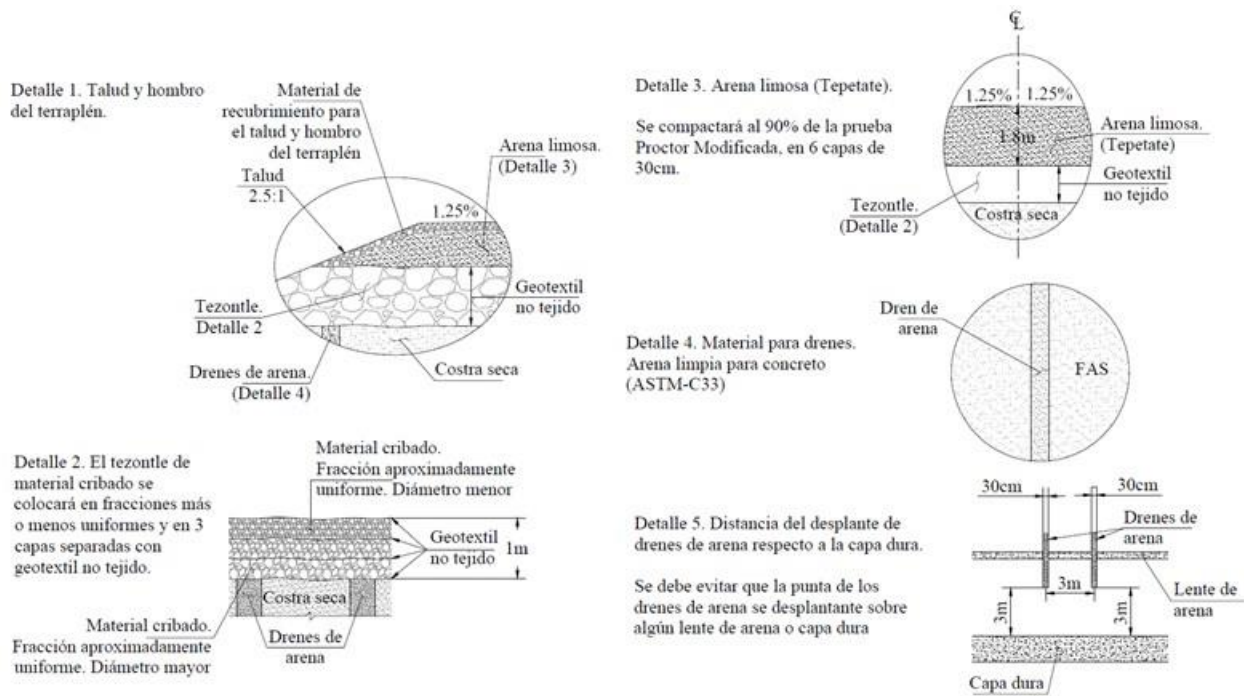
Detalles indicados en la Fig. 4.1.6.34
